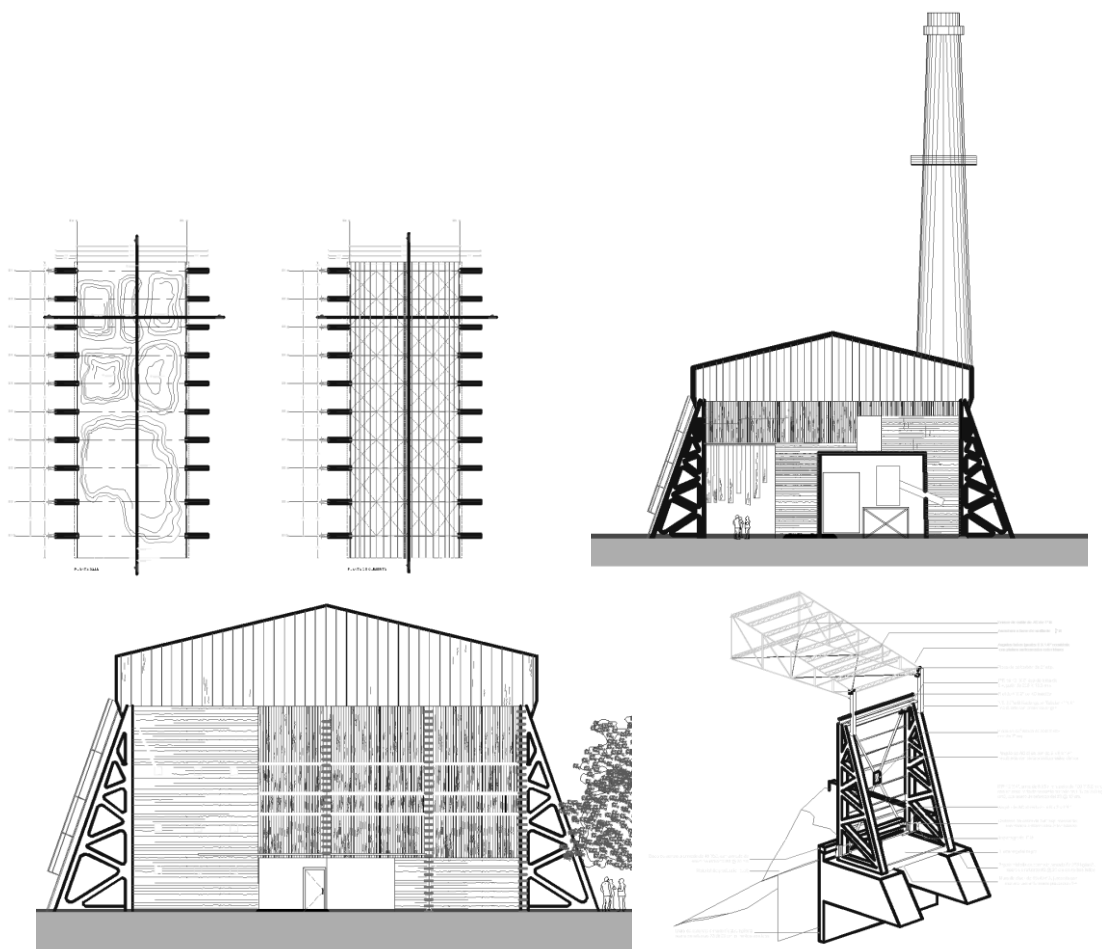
Ejemplo de la planimetría del levantamiento arquitectónico.
